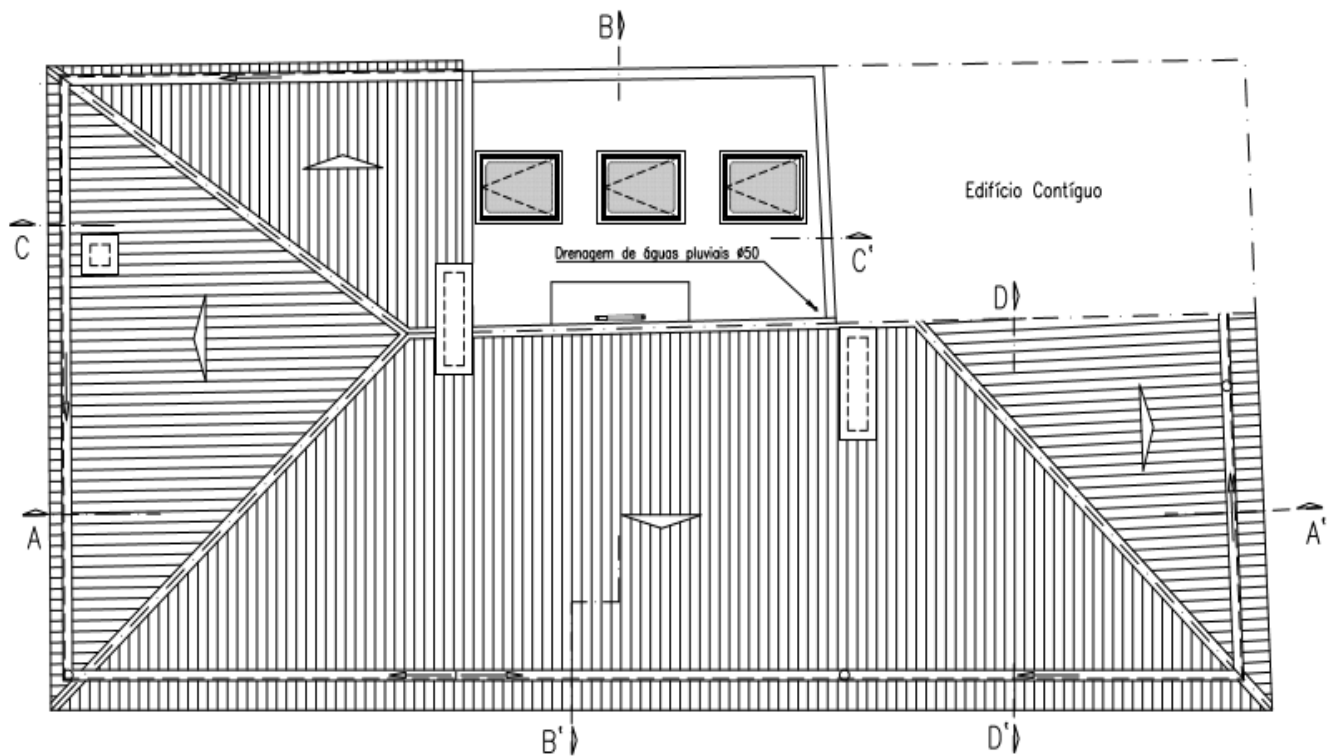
Planta da proposta de cobertura (Fonte: Projeto de Arquitetura)
